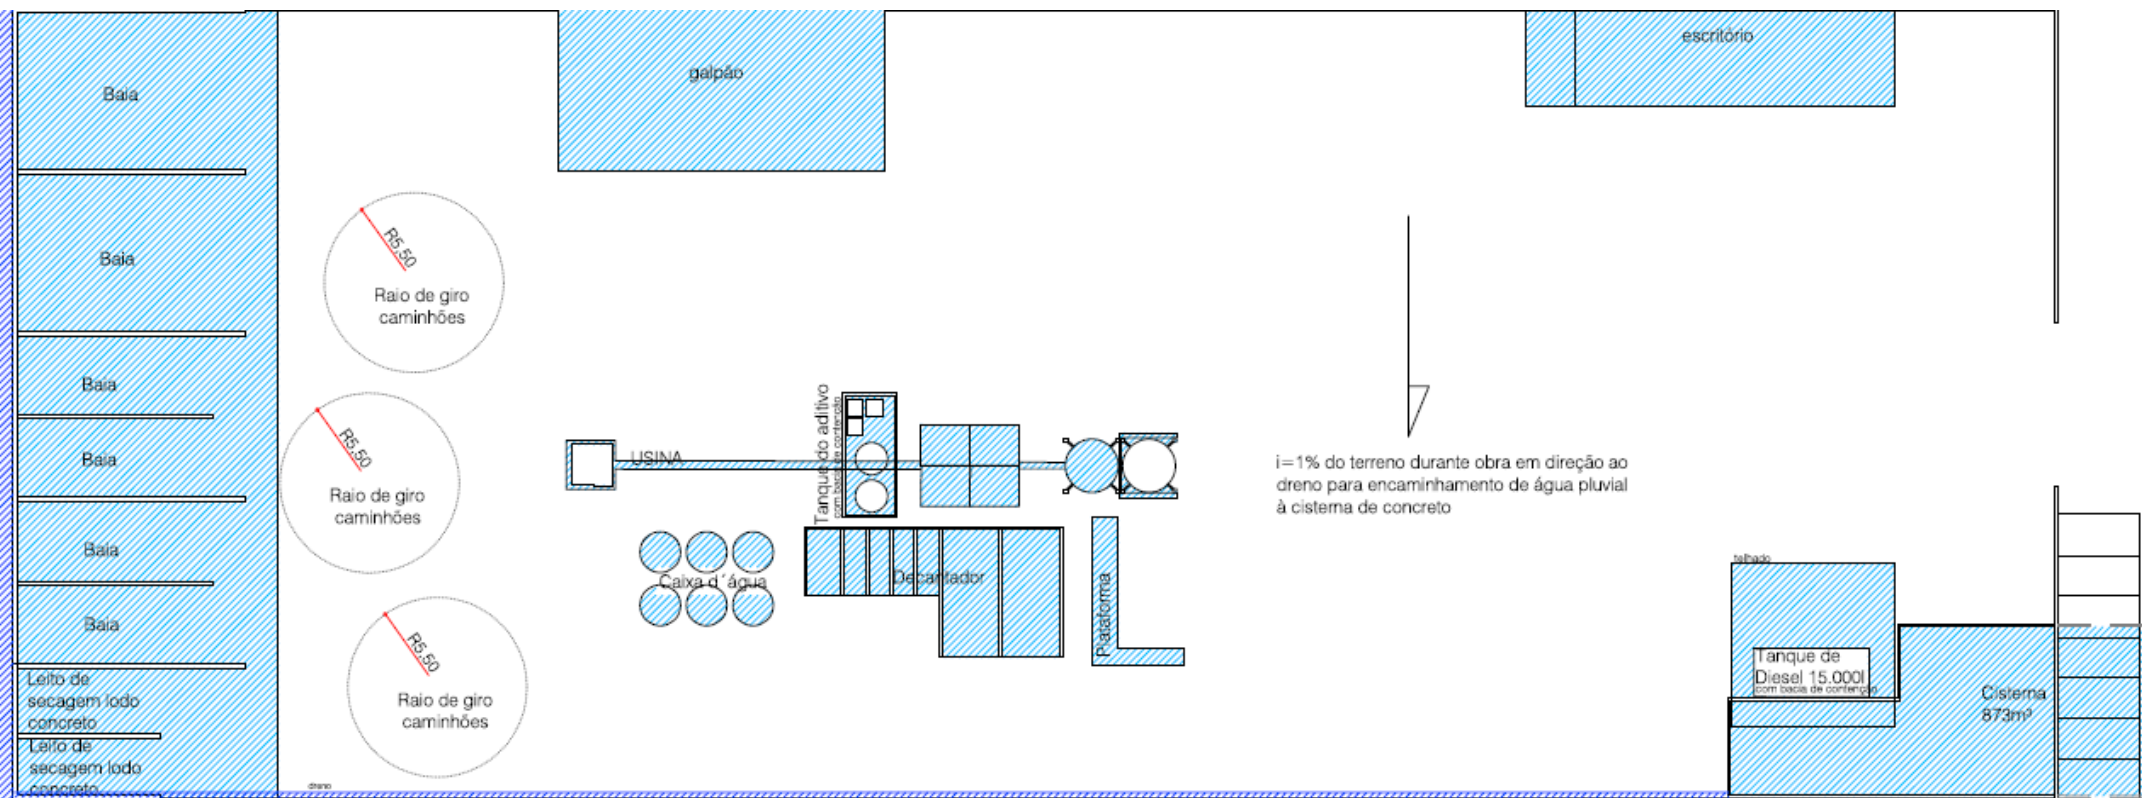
ilustração da planta do canteiro de obras. Fonte: Projeto arquitetônico.
